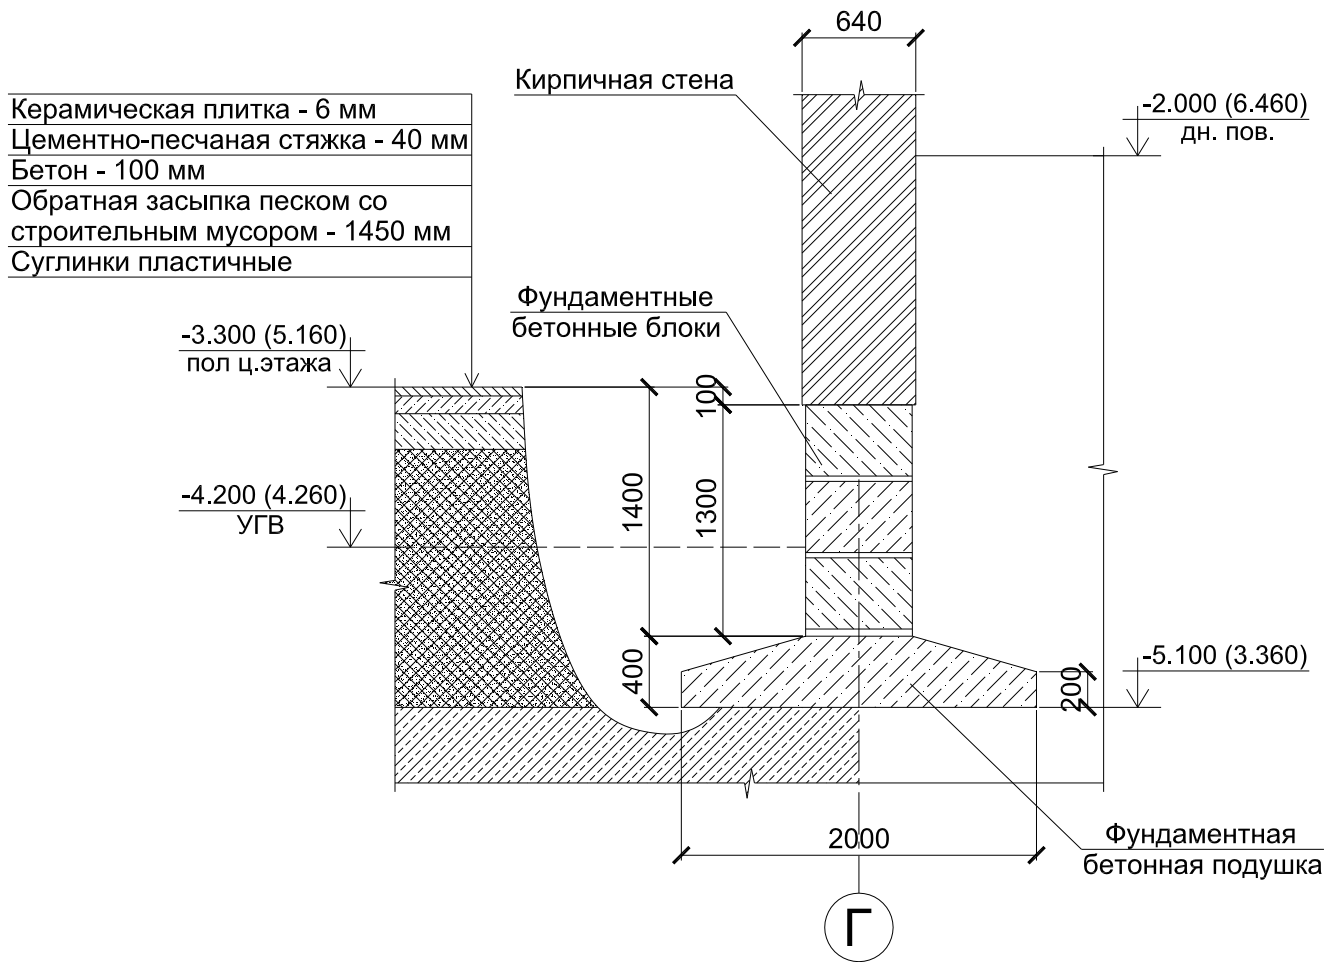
Эскиз поперечного сечения фундамента.
